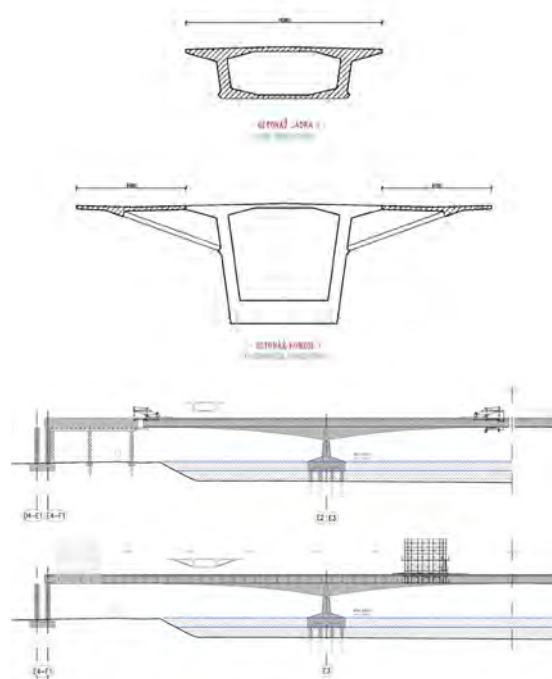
Fases de construcción de la sección tipo del tablero. Detalle del proceso constructivo del tablero.
